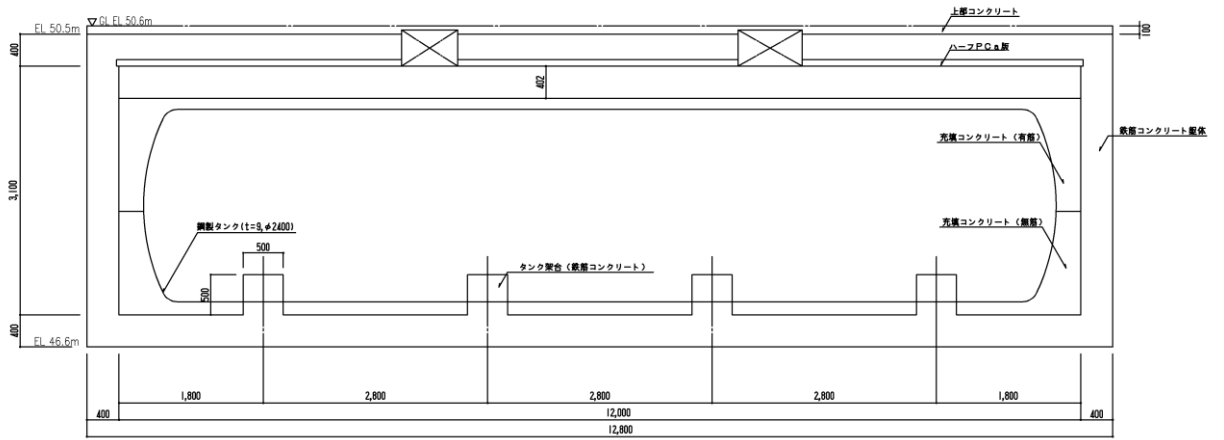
緊急時対策所用燃料地下タンク 断面図 (B-B 断面) (単位: mm)
